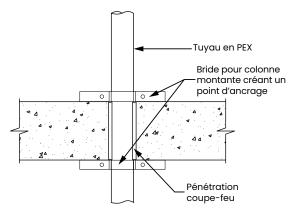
Example de point d'ancrage 2 (tuyauterie verticale)
